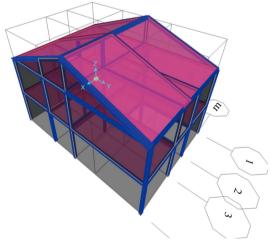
Steel-concrete composite structure model 图 5. 钢 - 混凝土组合结构模型图
